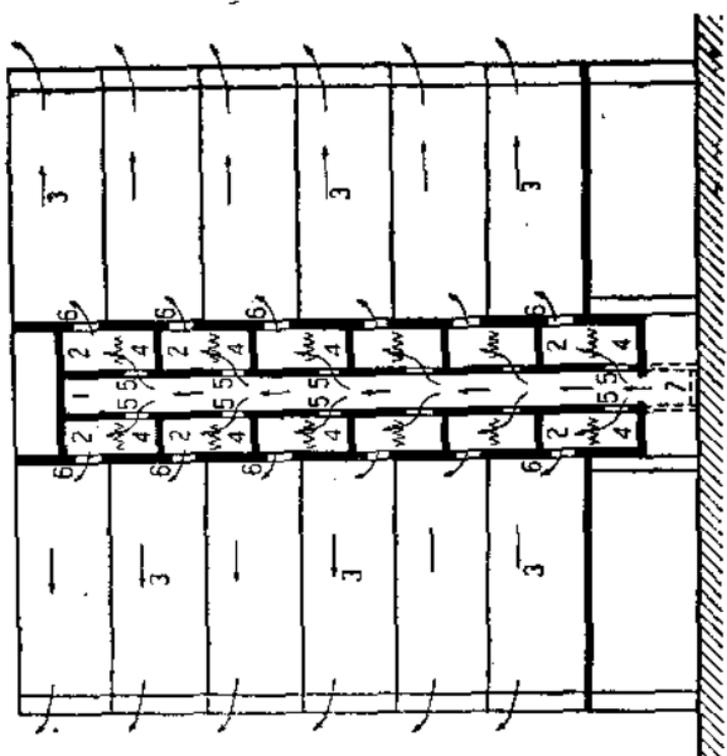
Схема обогрева и вентиляции батарейного брулера:
